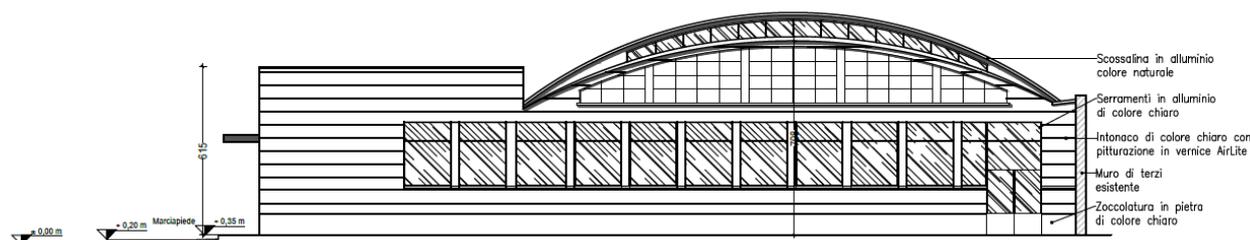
Prospetto nuovo edificio, visto da Ovest
